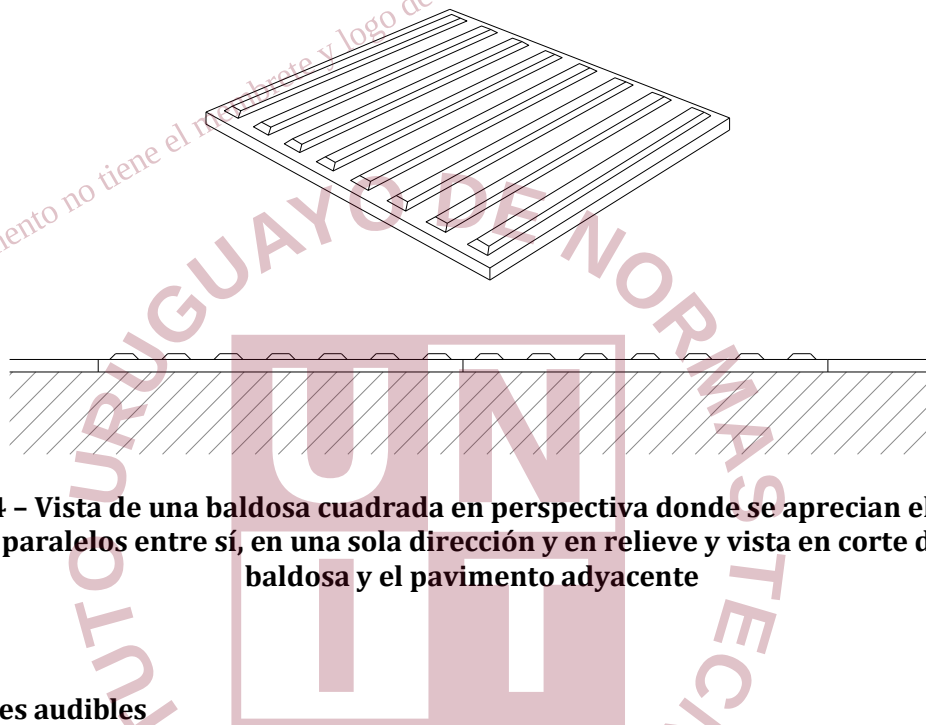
Vista de una baldosa cuadrada en perspectiva donde se aprecian elementos prismáticos paralelos entre sí, en una sola dirección y en relieve y vista en corte del perfil de la baldosa y el pavimento adyacente
